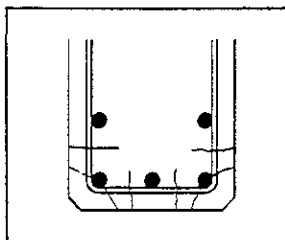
Grietas Longitudinales, Sección Recta
